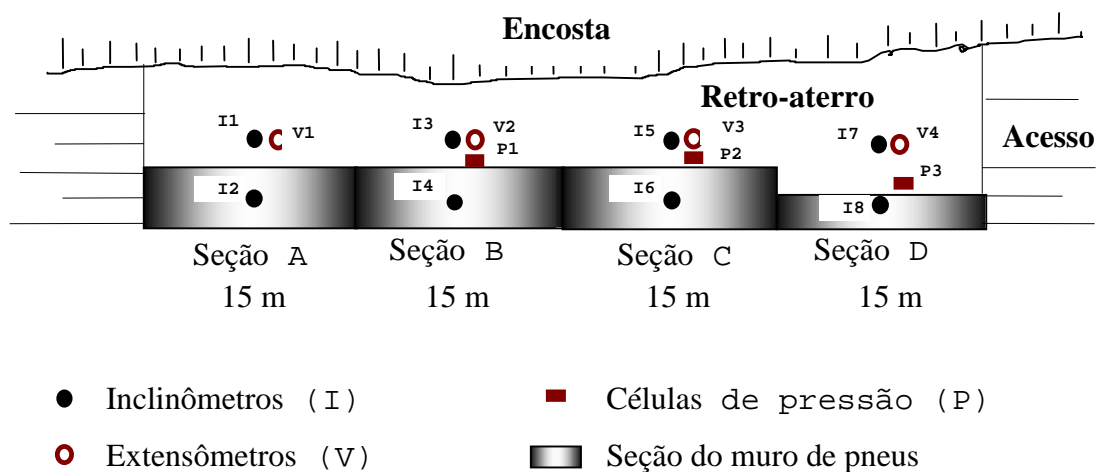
Planta esquemática do muro experimental e da instrumentação de campo.
